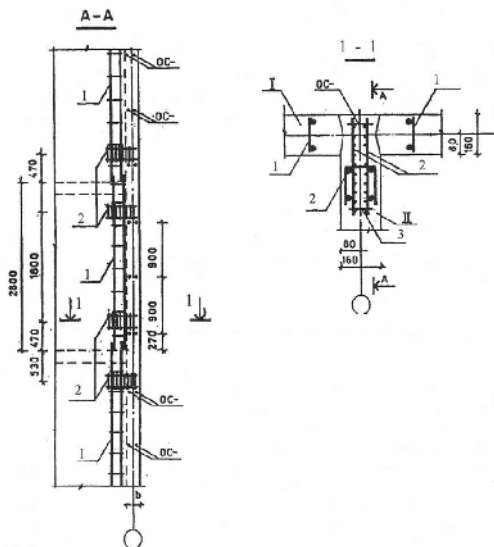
Схема устройства шпуночных связей при поэтажном бетонировании пересекающихся монолитных стен: 1 – арматурный каркас; 2 – каркас шпонки; 3 – отдельные стержни; О.С. – отдельные стержни
